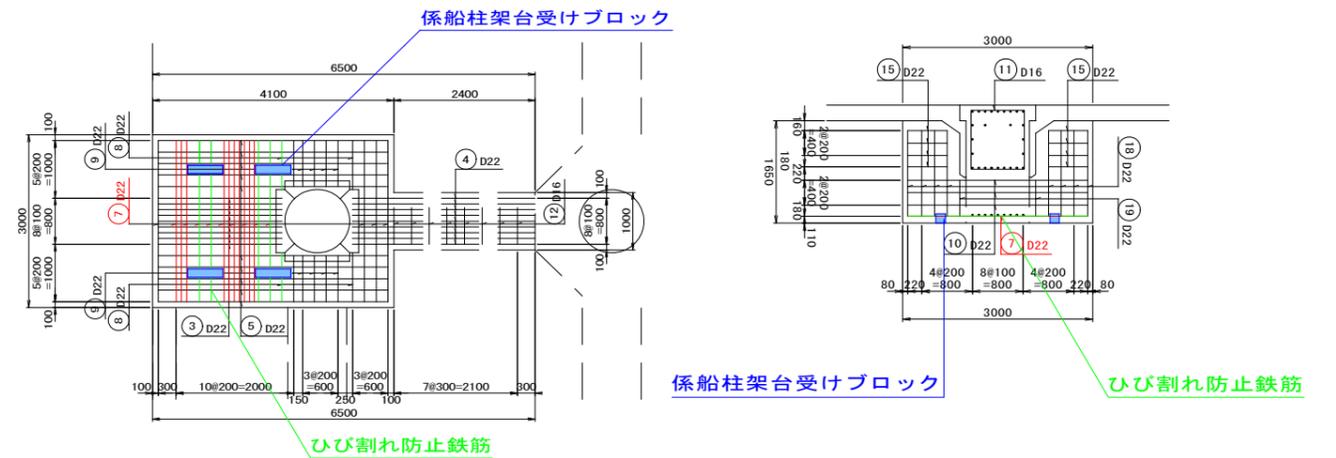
係船柱架台受けスペーサー配置図(左：正面図、右：平面図)
